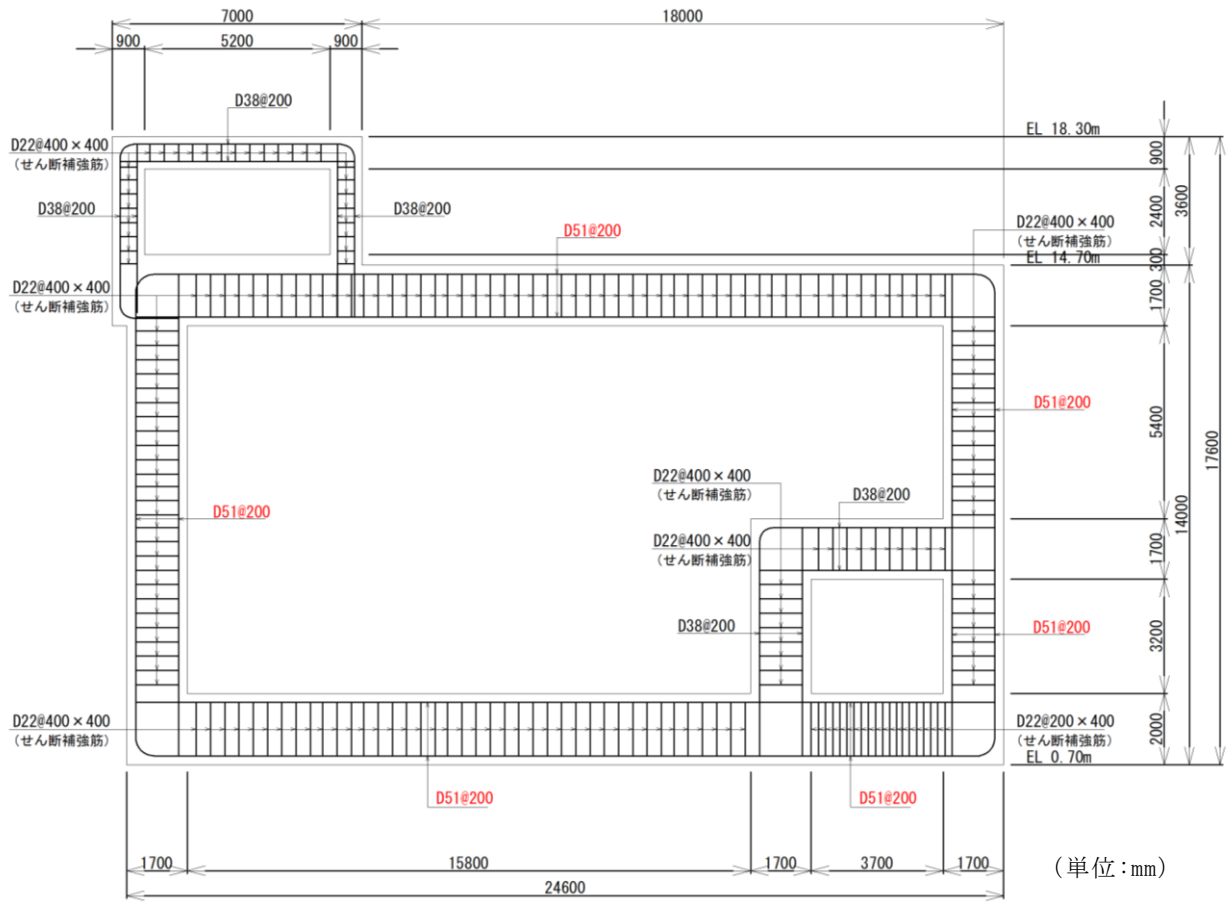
第 1 ベントフィルタ格納槽概略配筋図 (C-C 断面)
